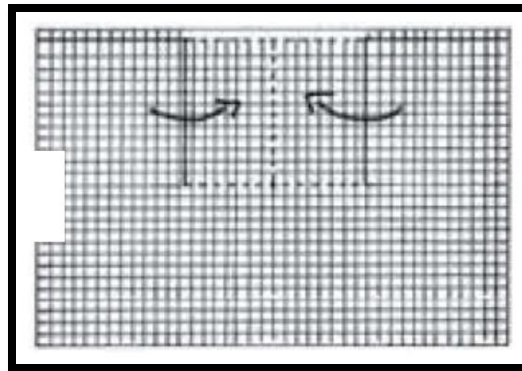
“Traslape de la geomalla para puertas y ventanas”
